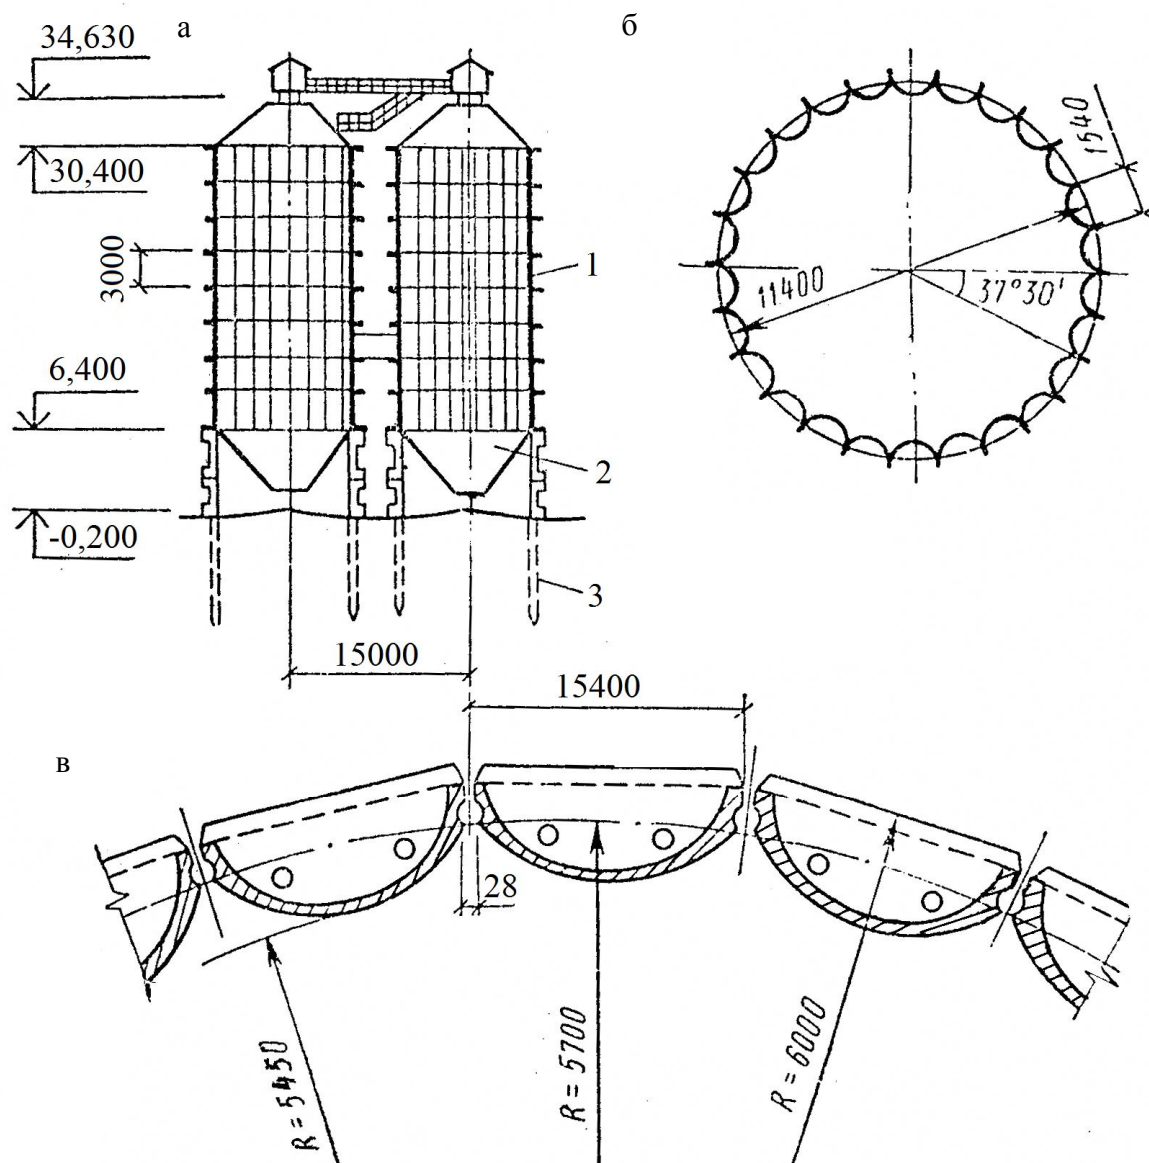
Конструктивные схемы сборного круглого силоса диаметром 12 м с панелями каннелюрного типа: а – разрез; б – план; в – деталь плана; 1 – панели-оболочки; 2 – металлические воронки; 3 – железобетонные сваи
